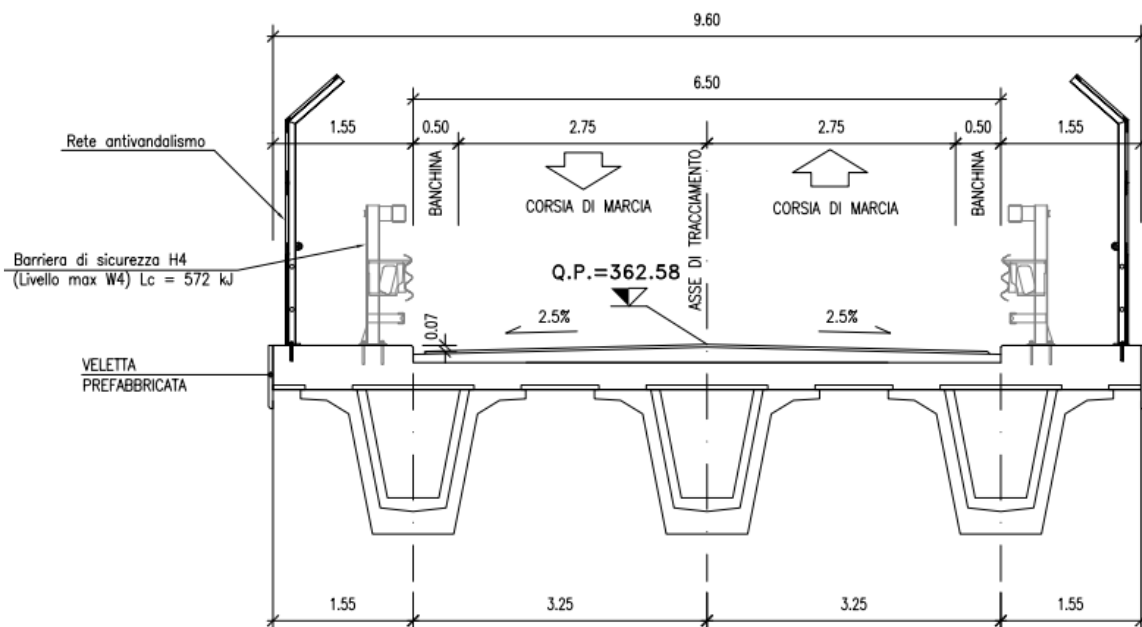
Sezione trasversale dell'impalcato in campata
